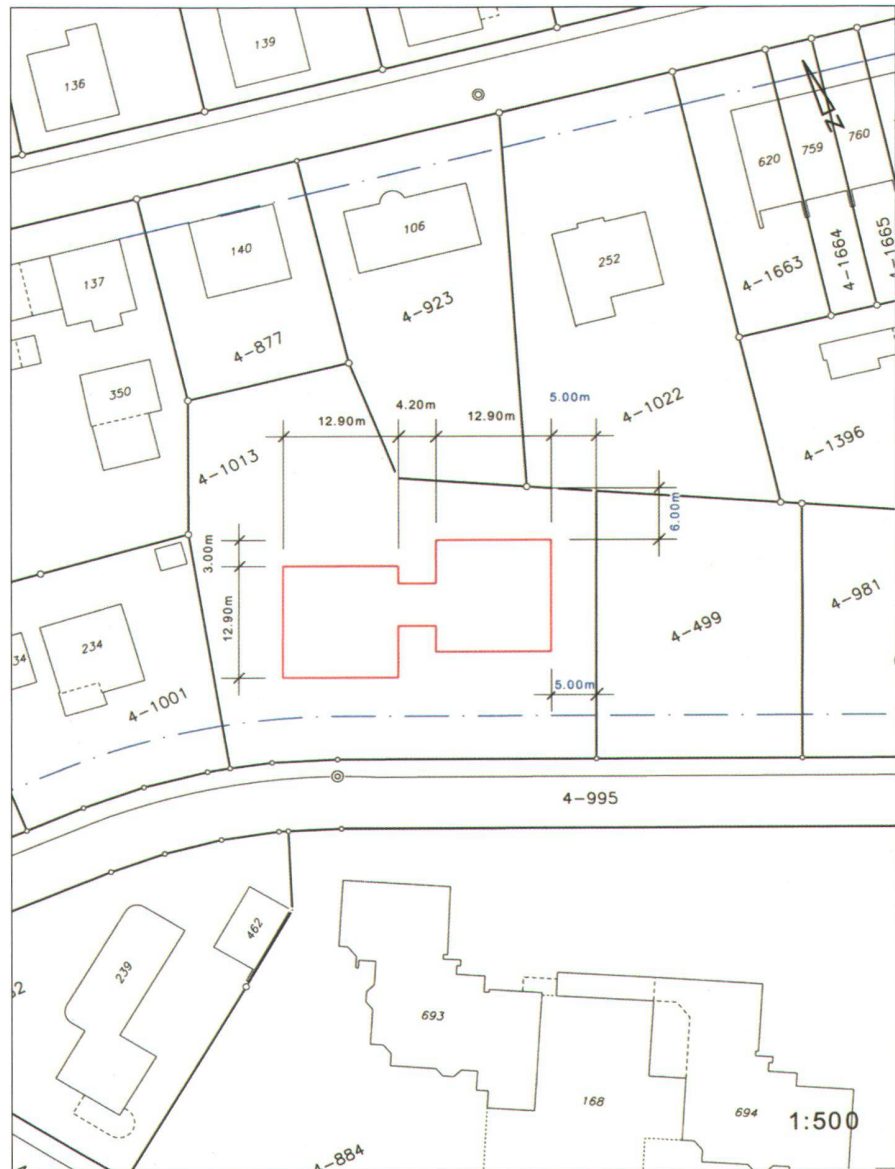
Umrisse definiert durch die baurechtlichen Abstände (Baugesuch, verkleinert).
